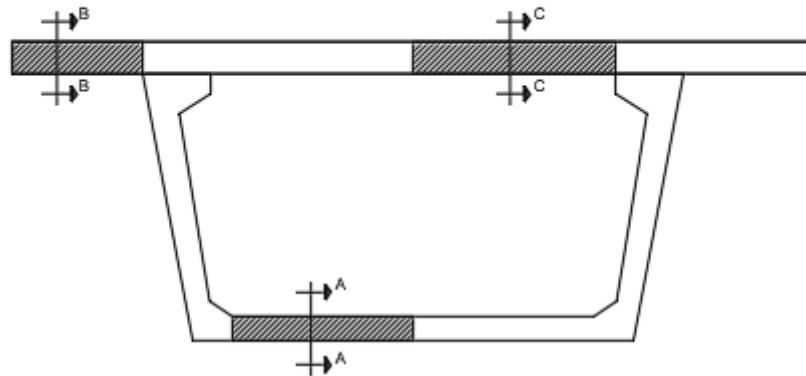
Esquema de secciones para comprobación de rasante en la sección transversal de la viga + losa
